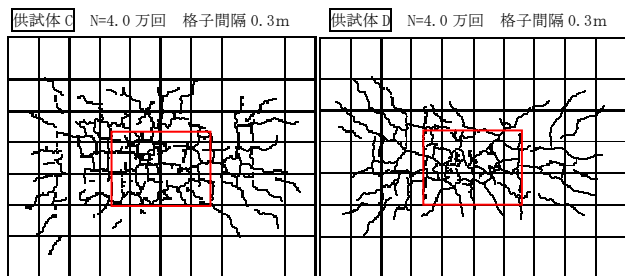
床版下面のひび割れ図 (供試体 C, D)
